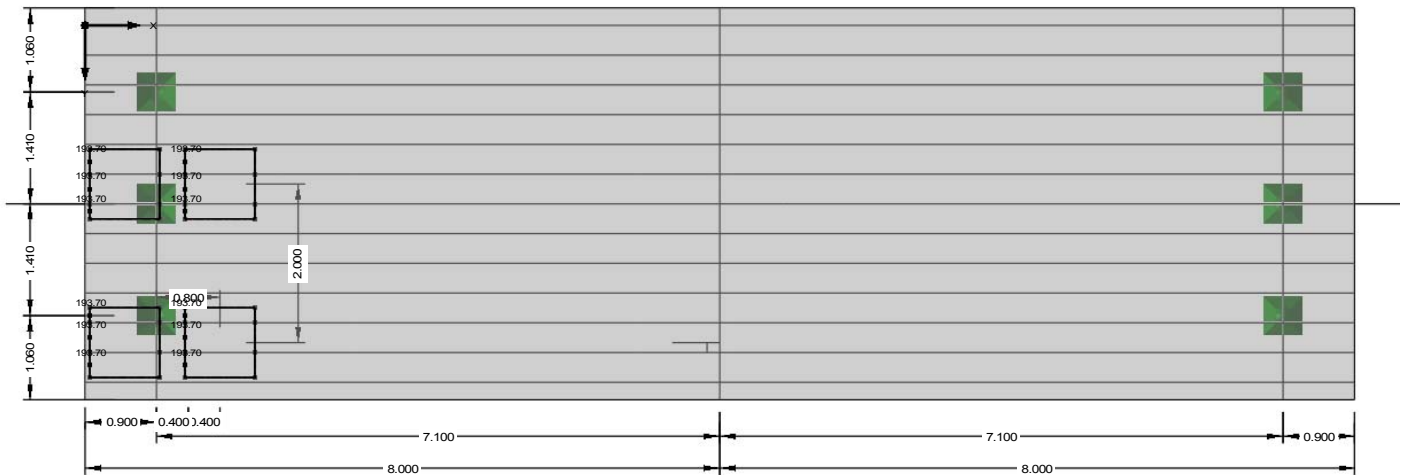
Darstellung der Angriffsflächen der Achslasten im Grundriss
